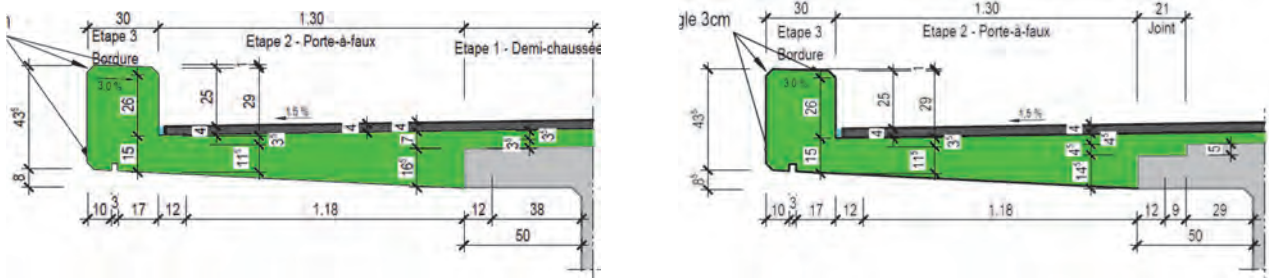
Détails de la dalle élargie sur appuis (gauche) et en travée (droite) par un porte-à-faux en CFUP armé
